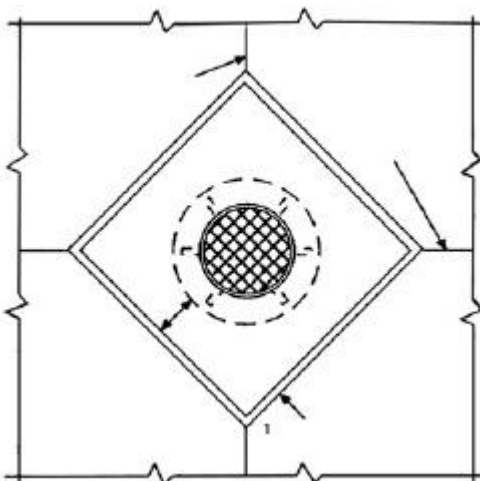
b.16 Junta de expansion drenaje sanitario.
